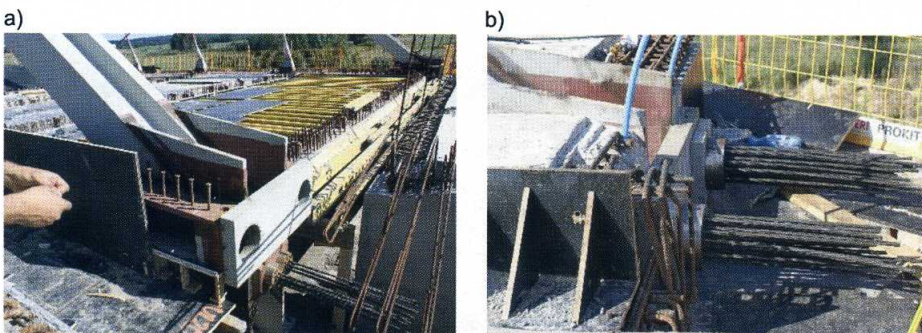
Ilustracja montażu konstrukcji stalowej [9]
